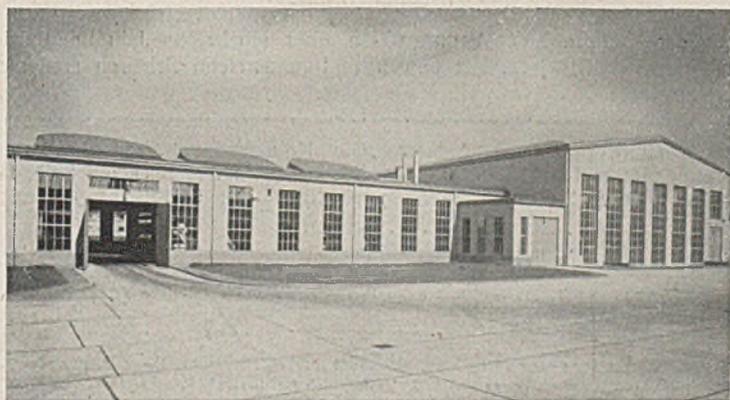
Halle III. Außenansicht und Anschluß an Halle II.
